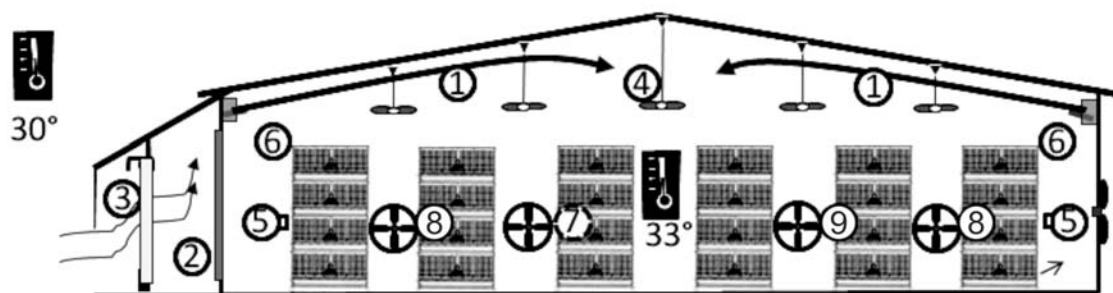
Вентиляция без подачи приточного воздуха через крышу
